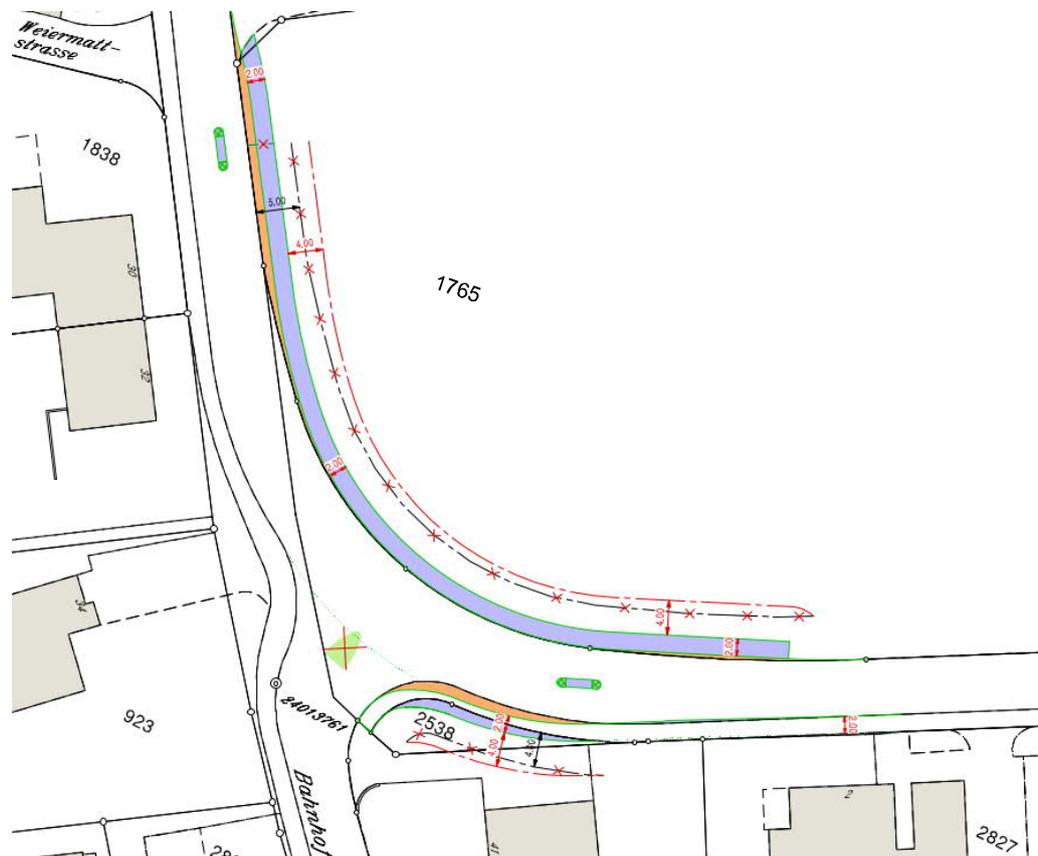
Ausschnitt der Änderungen an der Bannstrasse (Plan Nr. 325229/07)
